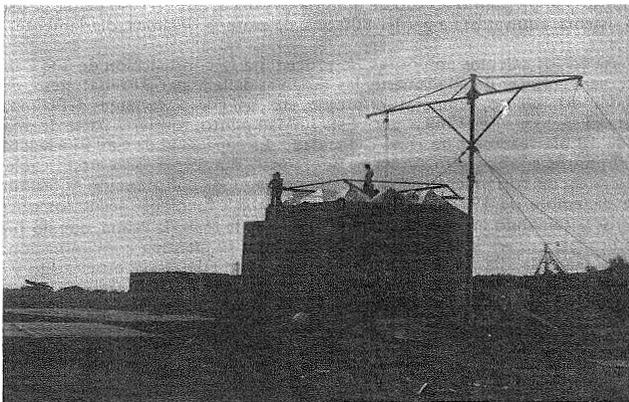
Planta "Las Acacias". 1978. En construcción de la Cámara Piloto, que formará parte de una batería de 18 cámaras más. Ver. Cuadro No. 1.
